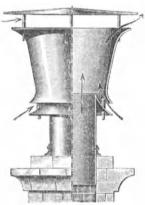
Schornfielnauffah jur Bentilation nach Wolpert.
